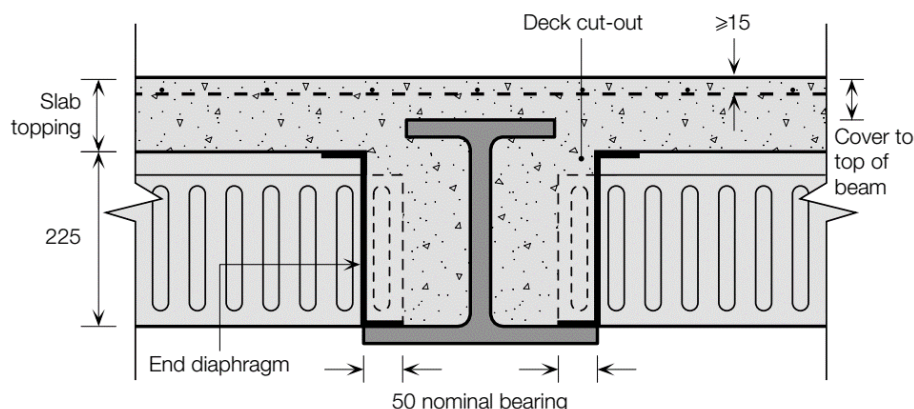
Esquema de instalação tipo em pavimentos tipo *Slimdek* (Tata Steel, 2007).
